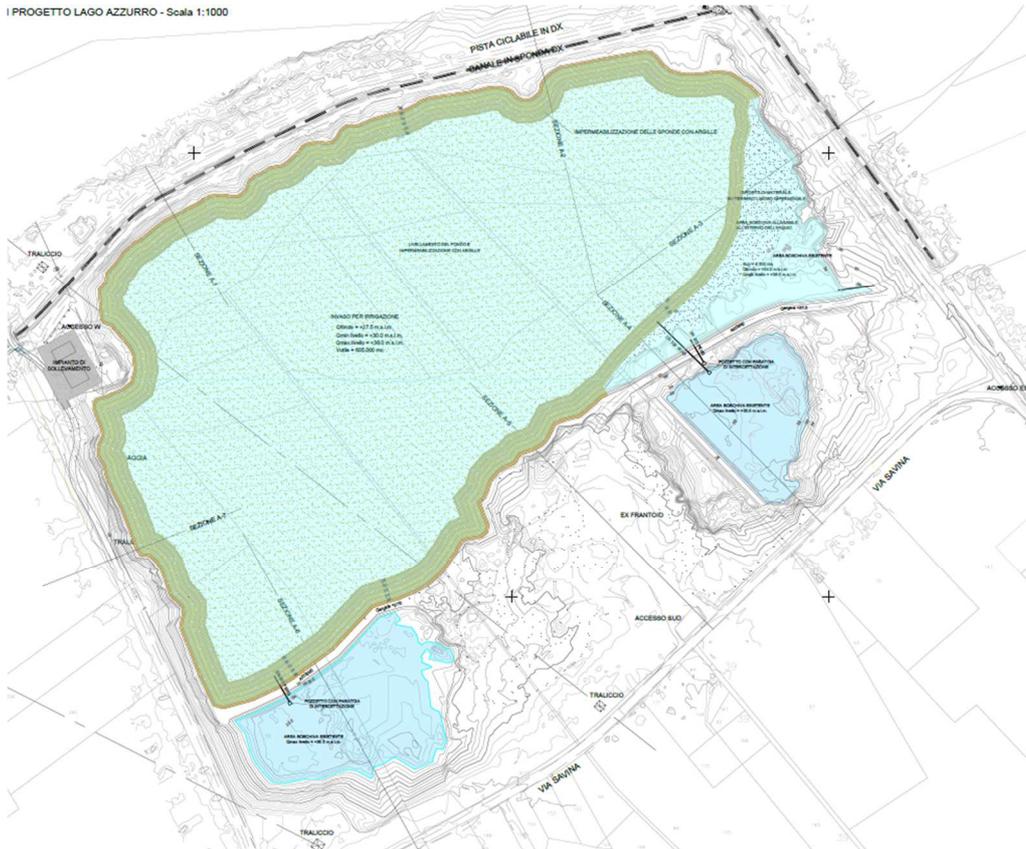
Planimetria di progetto del lago Azzurro del Progetto Definitivo
